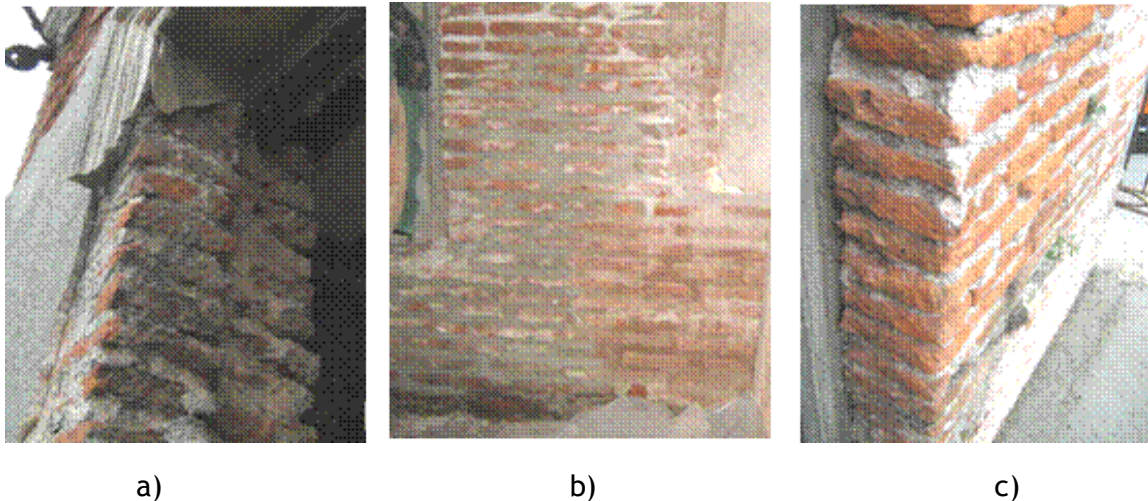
Muro de carga de fachada Vivienda en Perez Castellano 1301: a) Jamba fachada P. Alta, b) Paramento interior fachada P. Baja, c) Paramento exterior P. Alta
